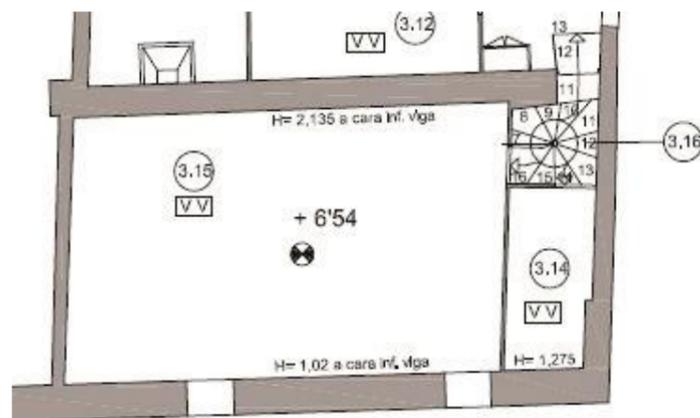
Planta cambrá 2ª y 3ª desembarco escalera caracol Fuente: Propia
